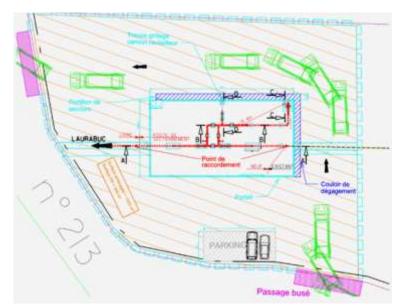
Plan schématique du poste de Saint-Julien-de-Briola
